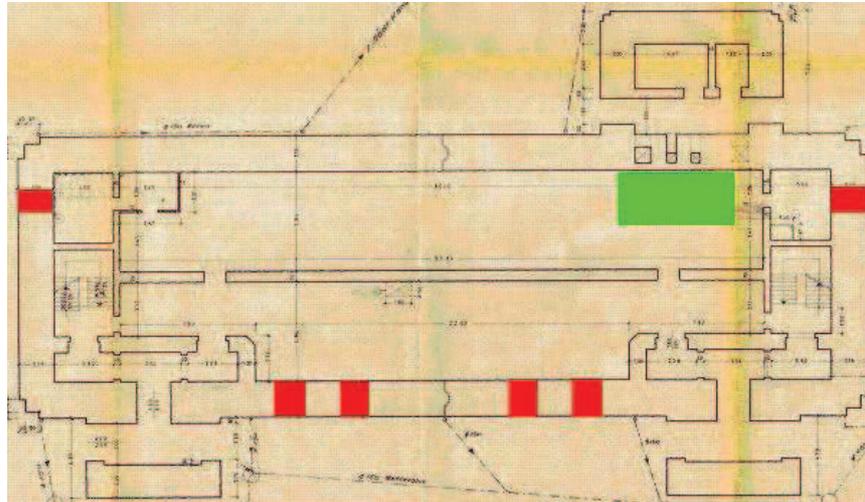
, Grundriss EG und 1.OG
